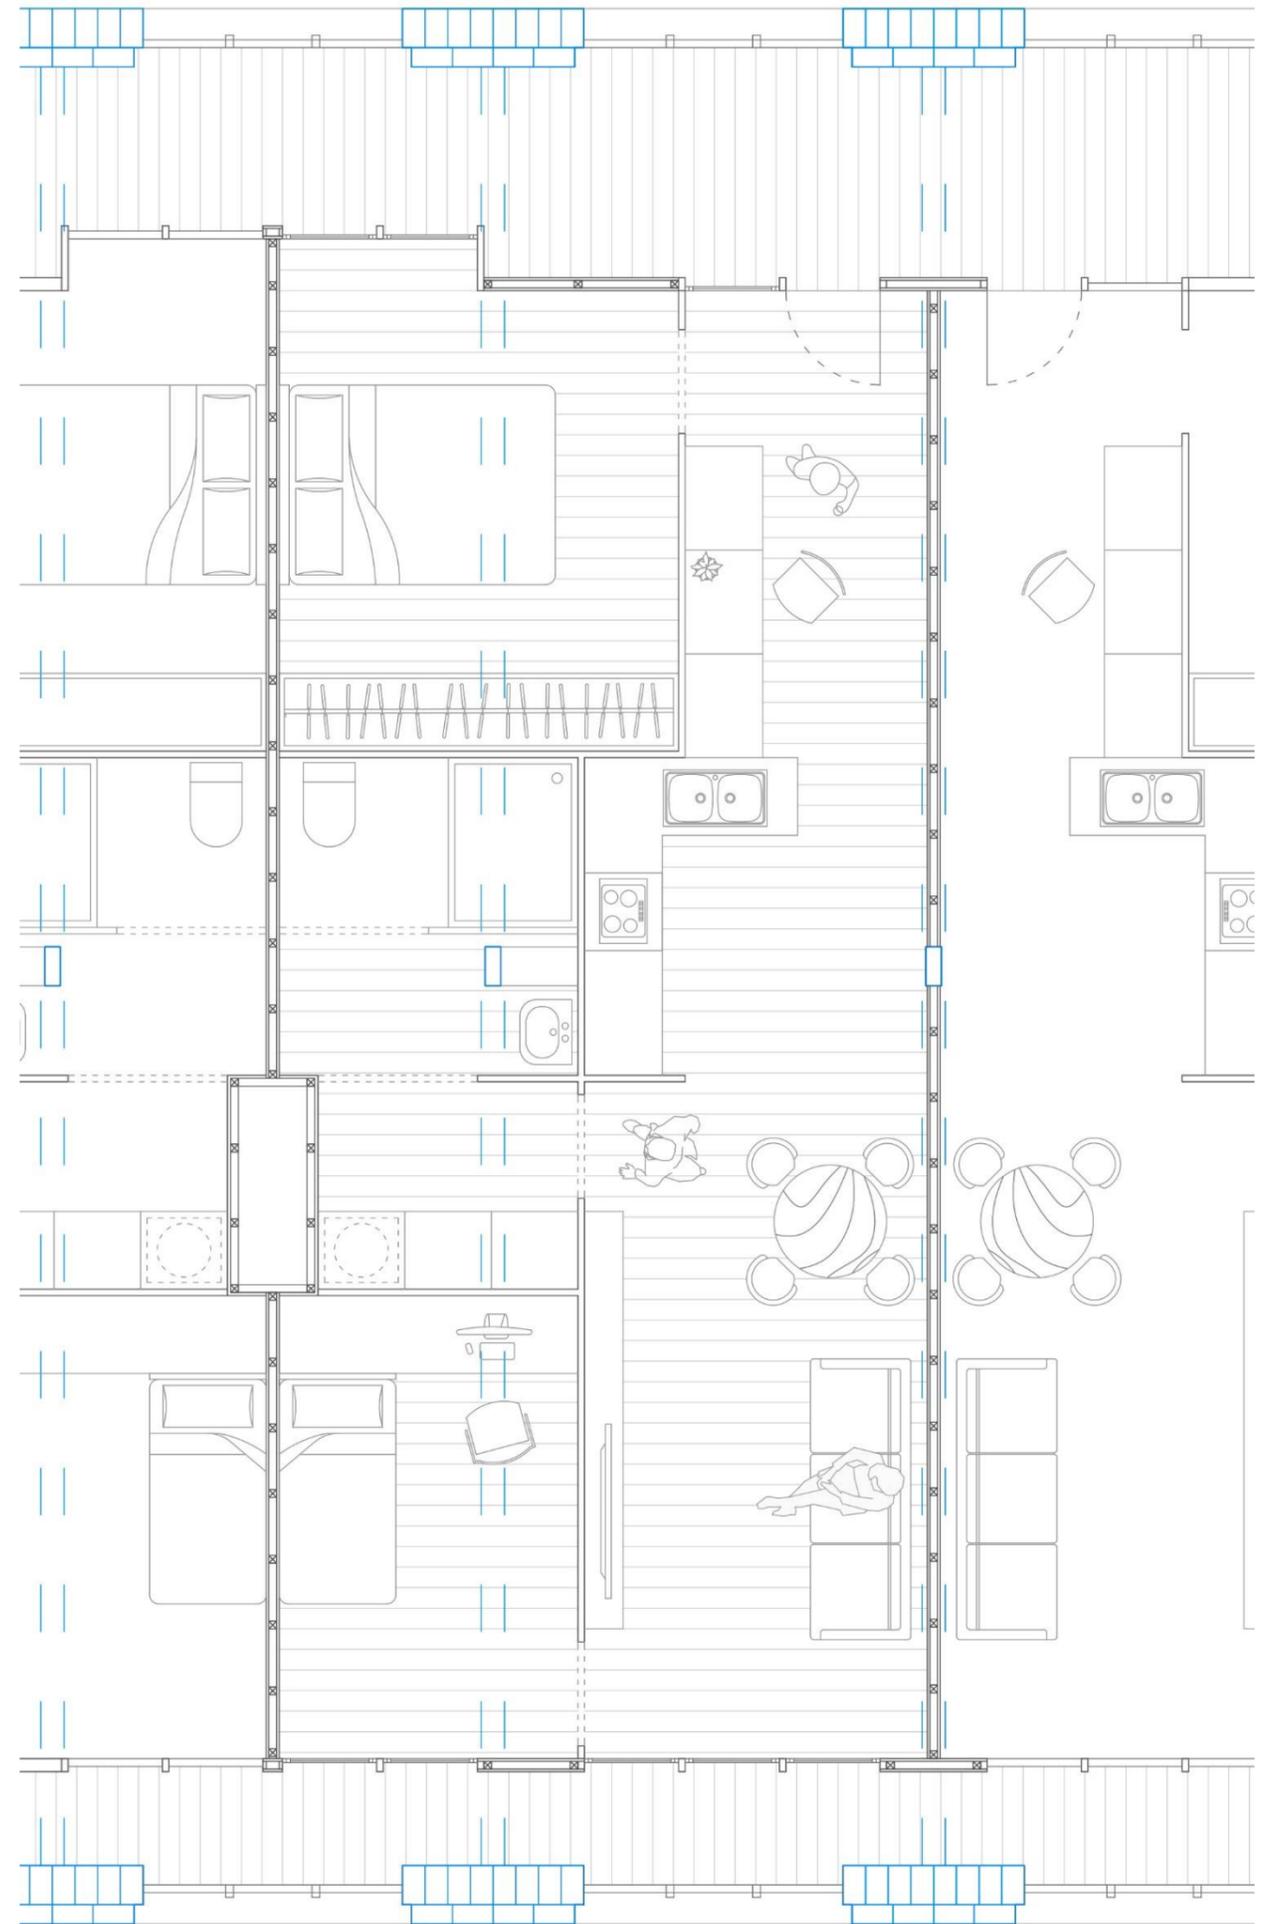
PLANO 1/50. Vivienda tipo intervenció
